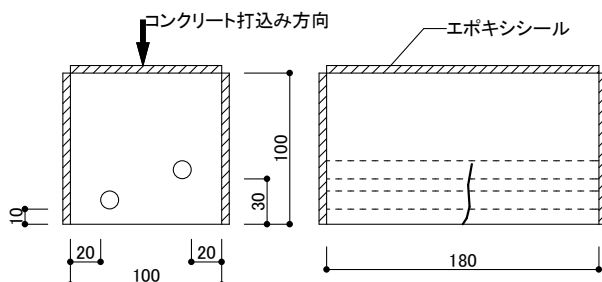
非貫通ひび割れ試験体(試験体タイプ B)
